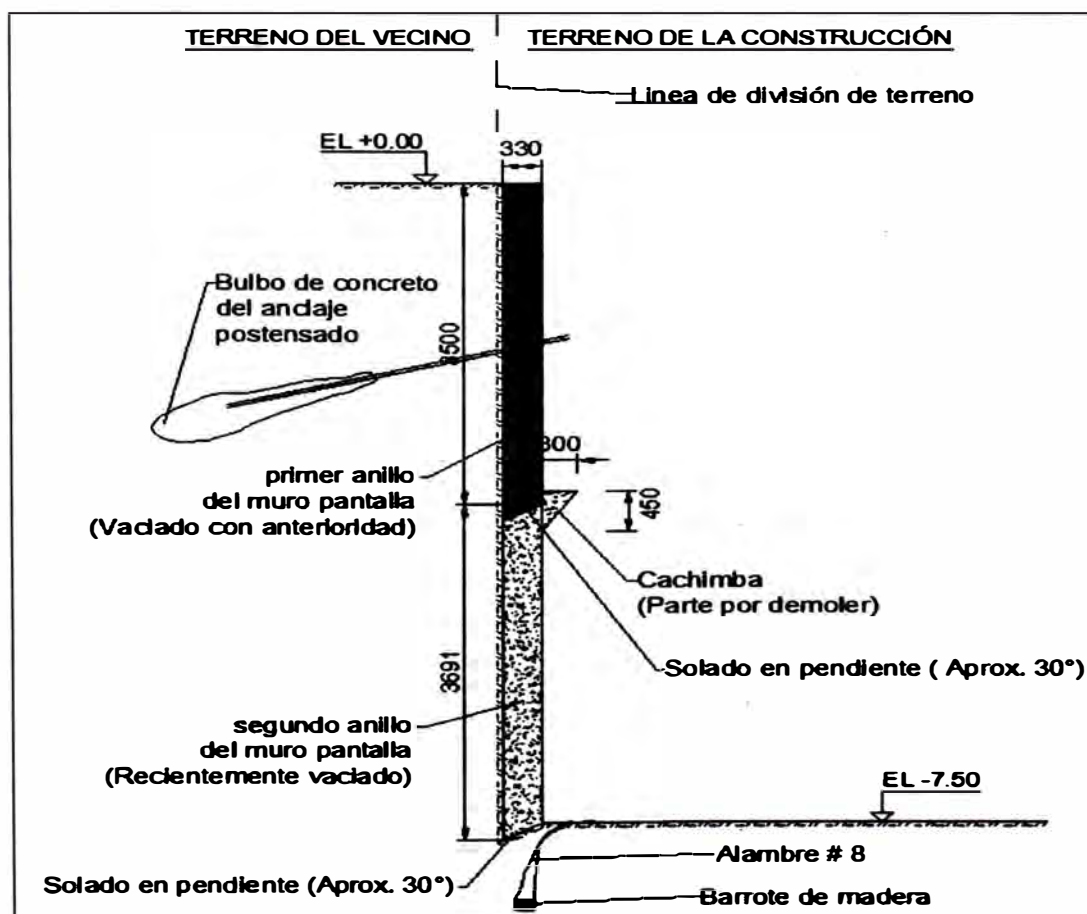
Detalle típico del encofrado de la cachimba y la plataforma de trabajo
